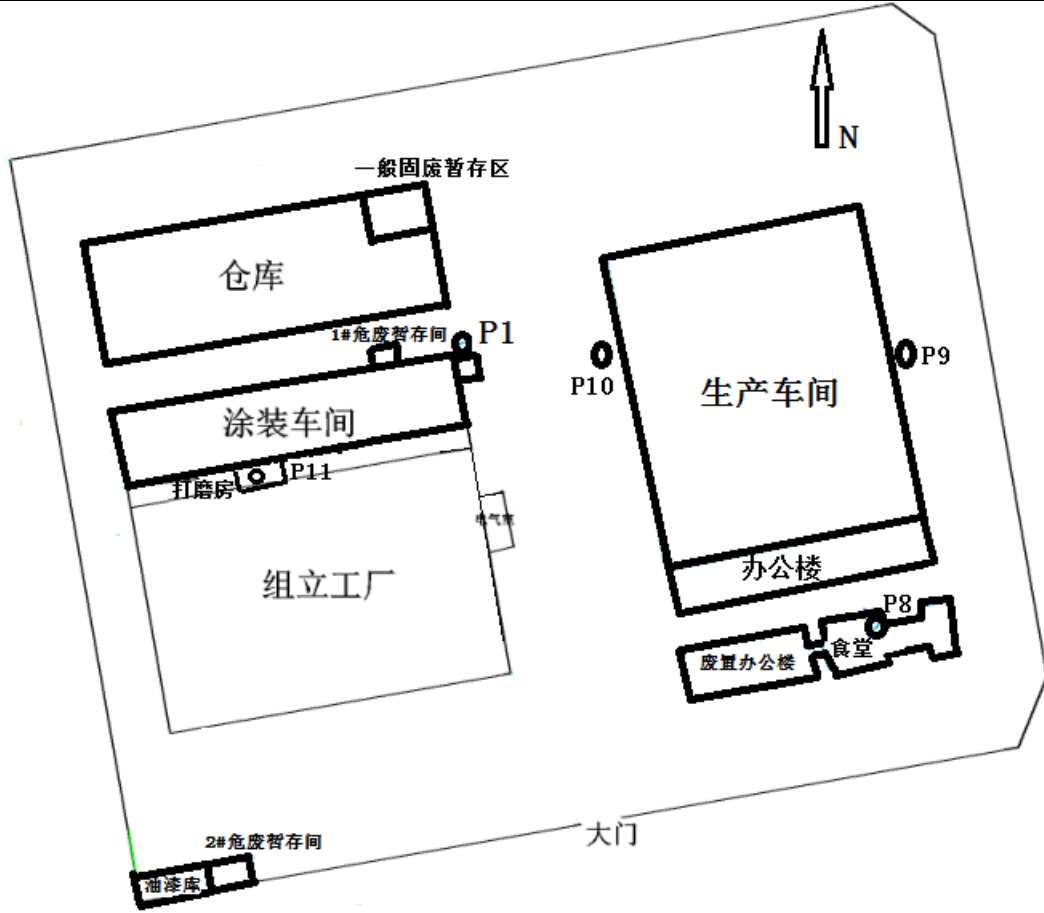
厂区总平面布置图（加粗部分为本项目内容）
